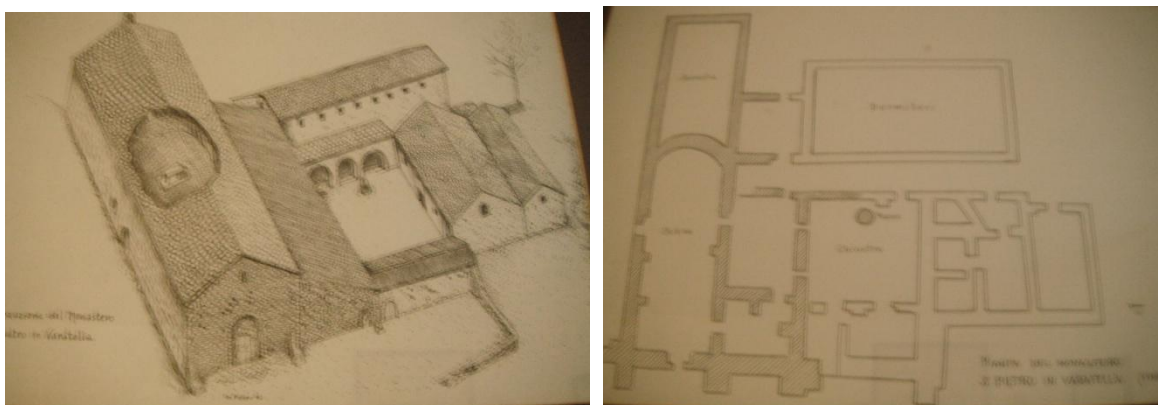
13 Il convento di San Pietro in Varatella, visione d'insieme e planimetria.
